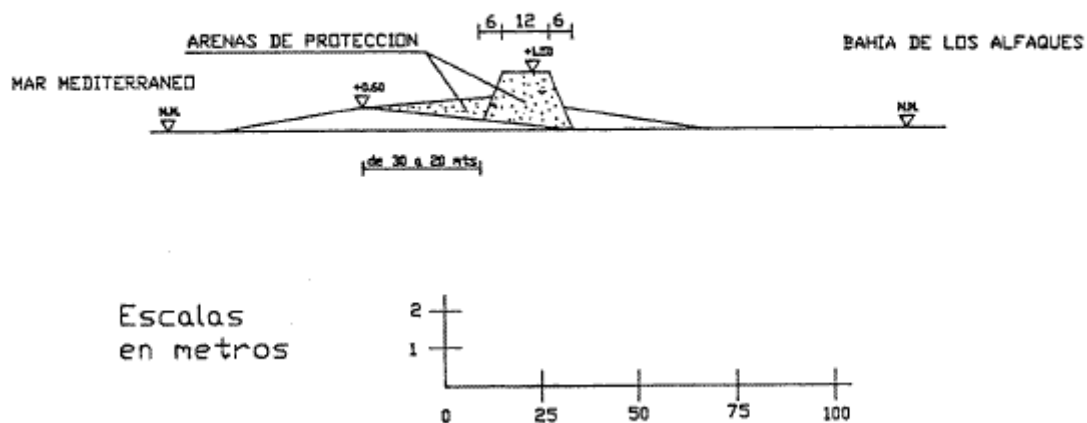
Perfil tipo de proyecto de la duna construida en la barra del trabucador.
